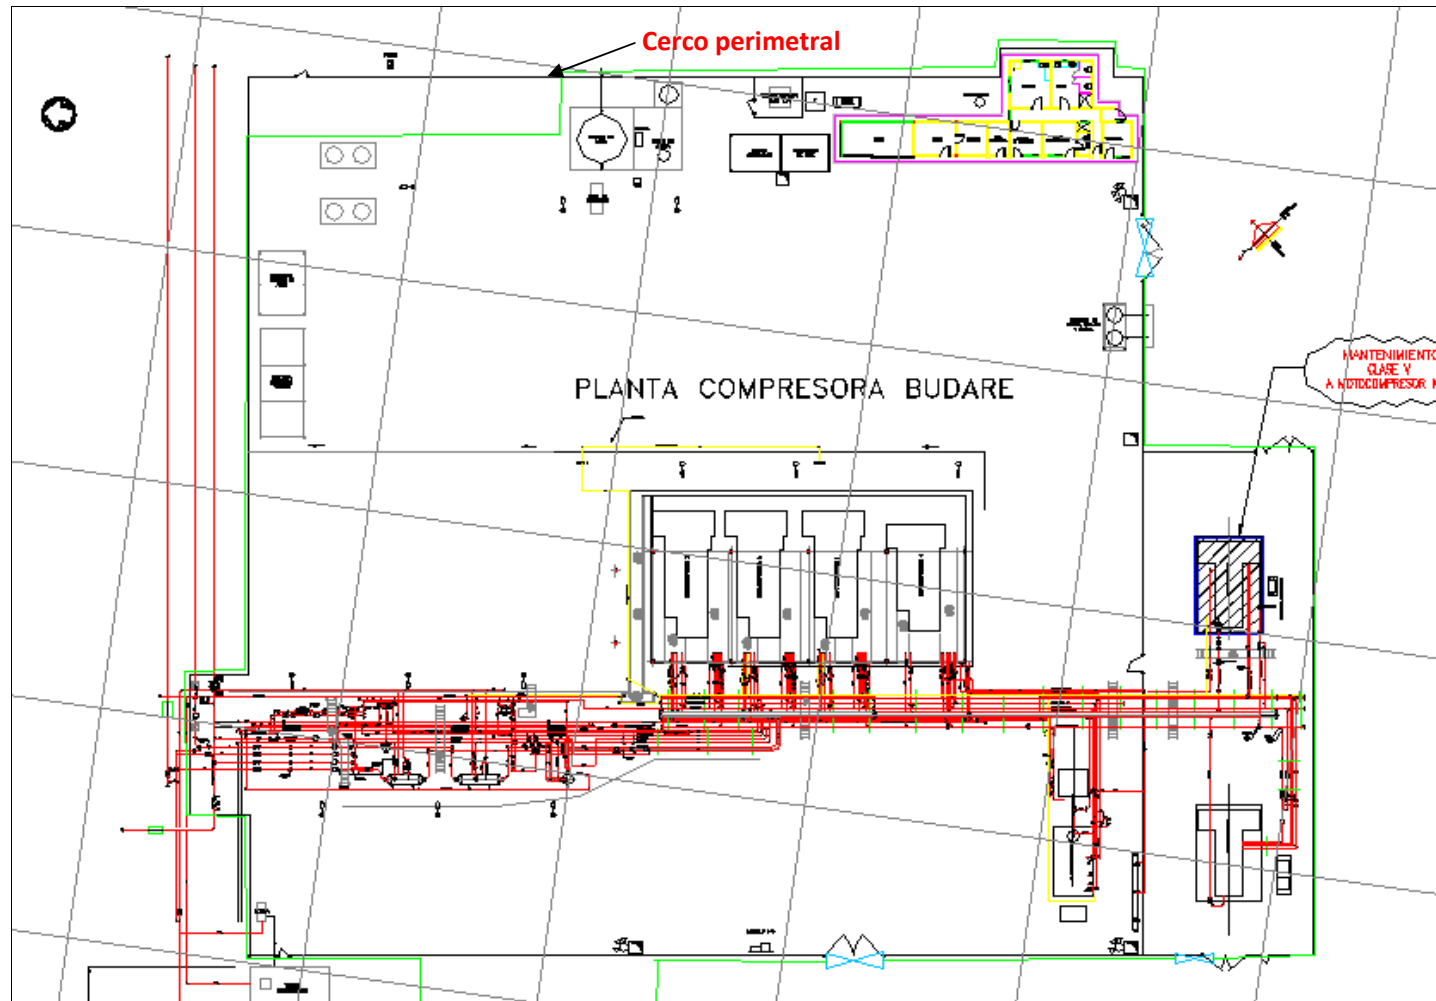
Vista en planta de la Planta Compresora Budare.
